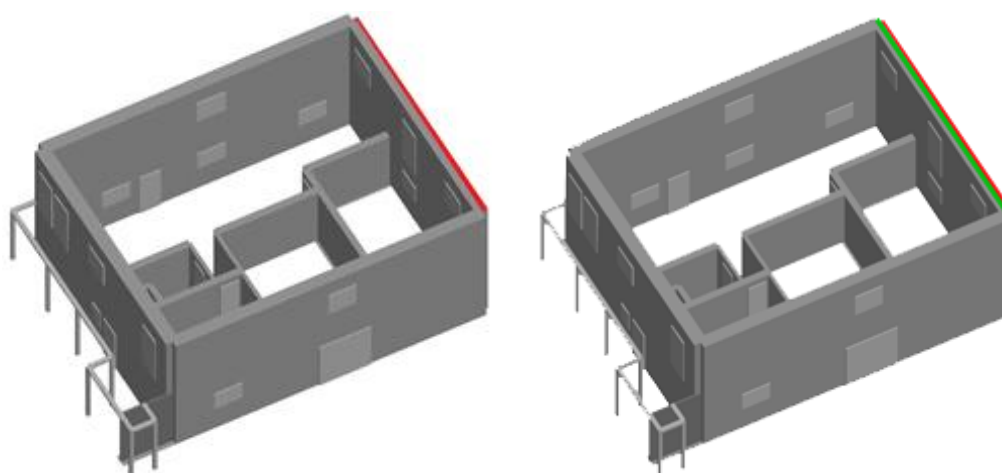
Comparação da execução de reboco armado numa face da fachada principal com a solução conjunta de introdução de tirantes ao nível do pavimento do sótão e execução de reboco armado numa face da mesma fachada
